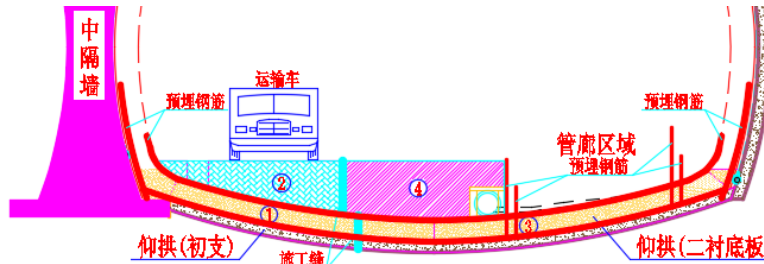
右幅仰拱及第一层仰拱填充施工断面图
